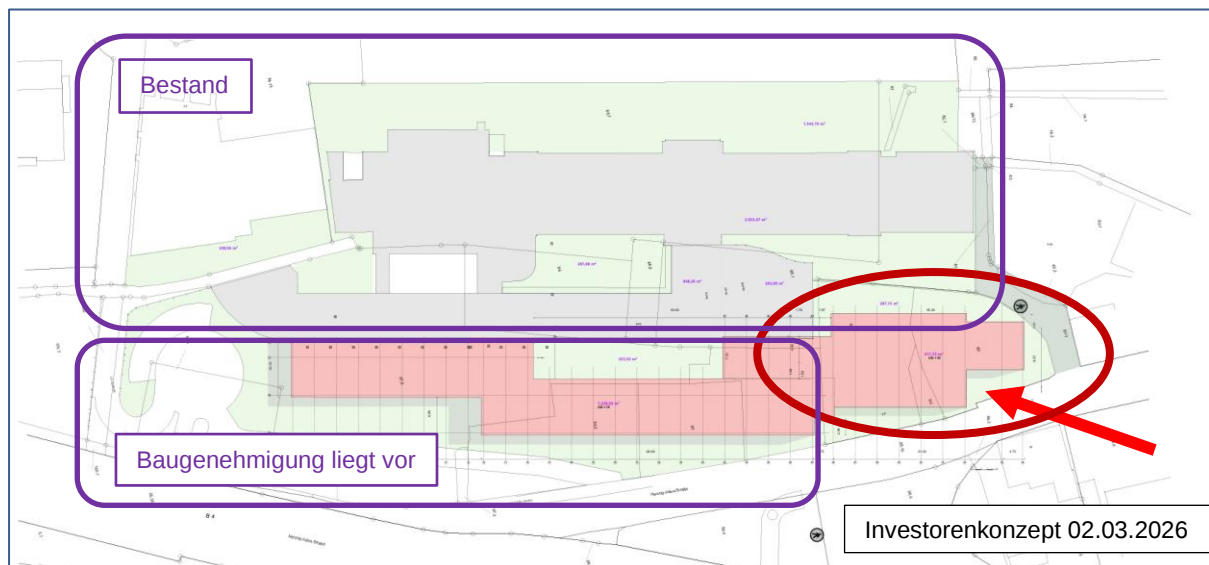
Lageplan mit Kennzeichnung des geplanten Anbaus und der Liegendkrankenanzufahrt
